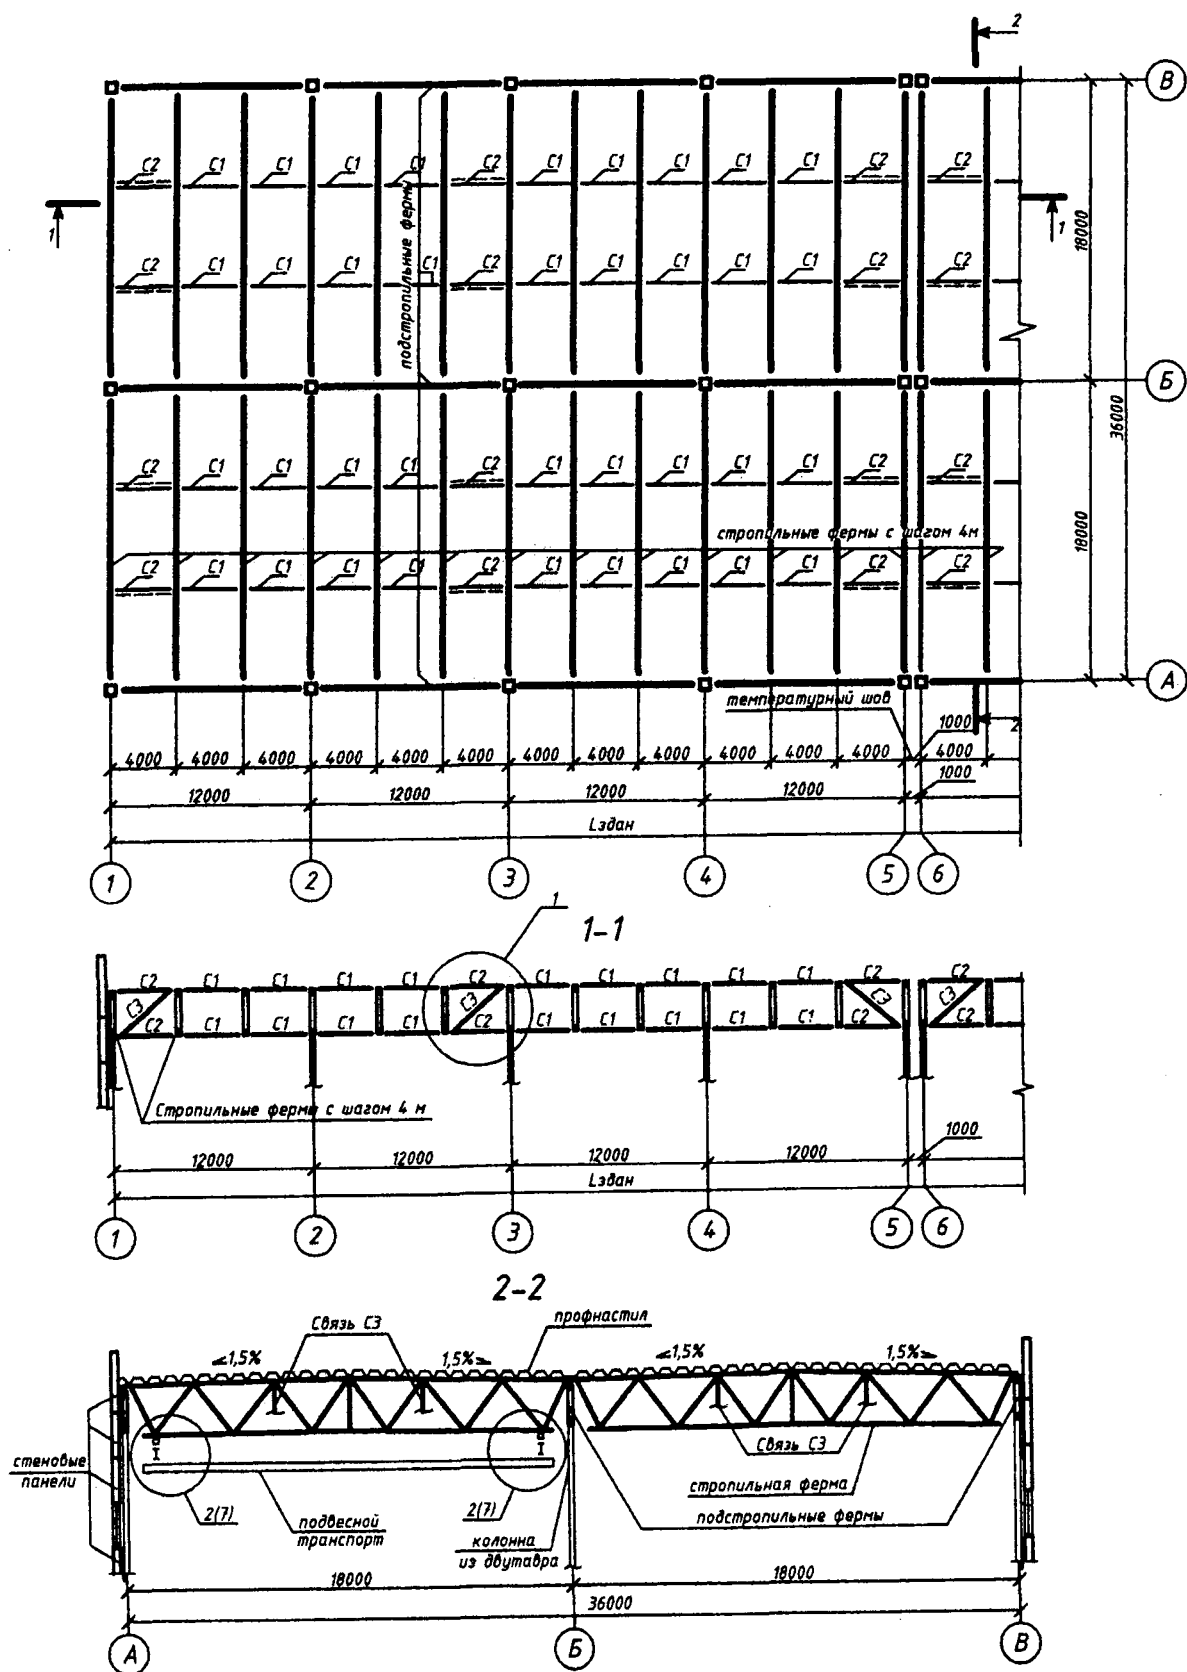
Схема расположения связей в покрытии поэлементного монтажа при пролете ферм 18 м
